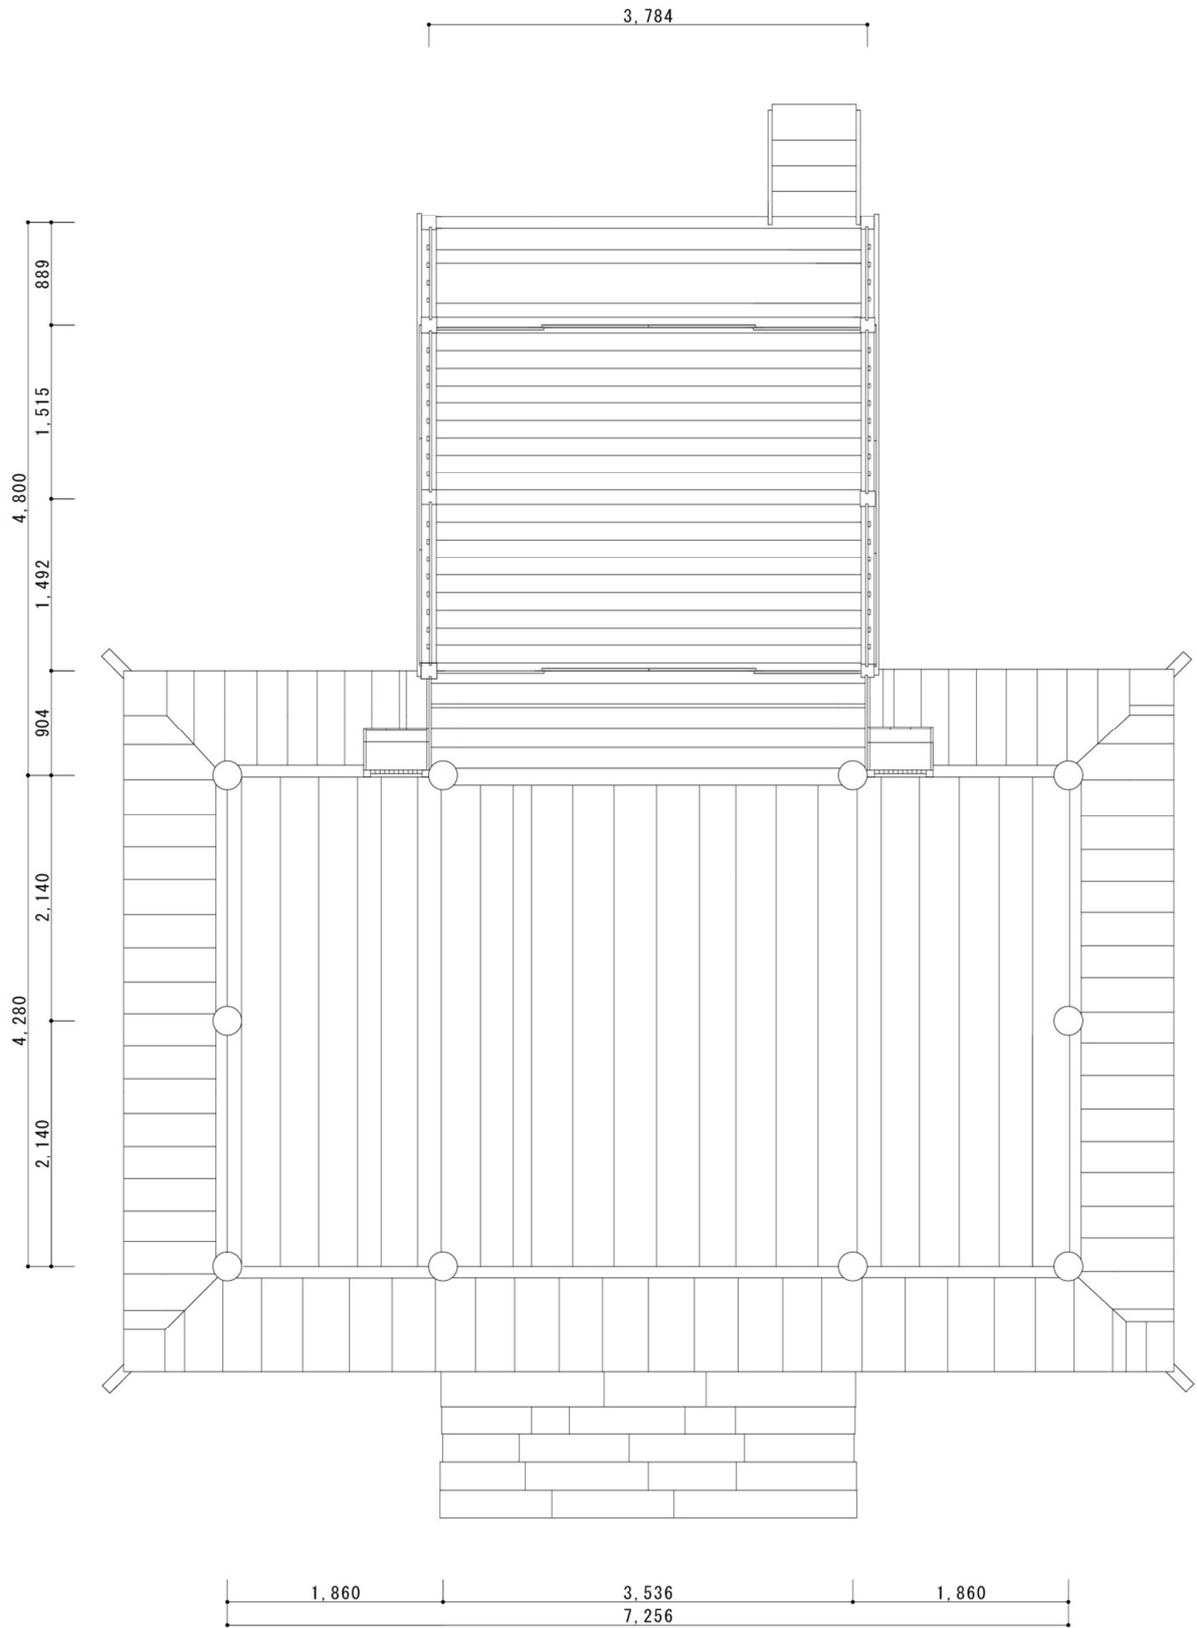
一宮八幡神社拝殿・申殿 平面図 1/50
